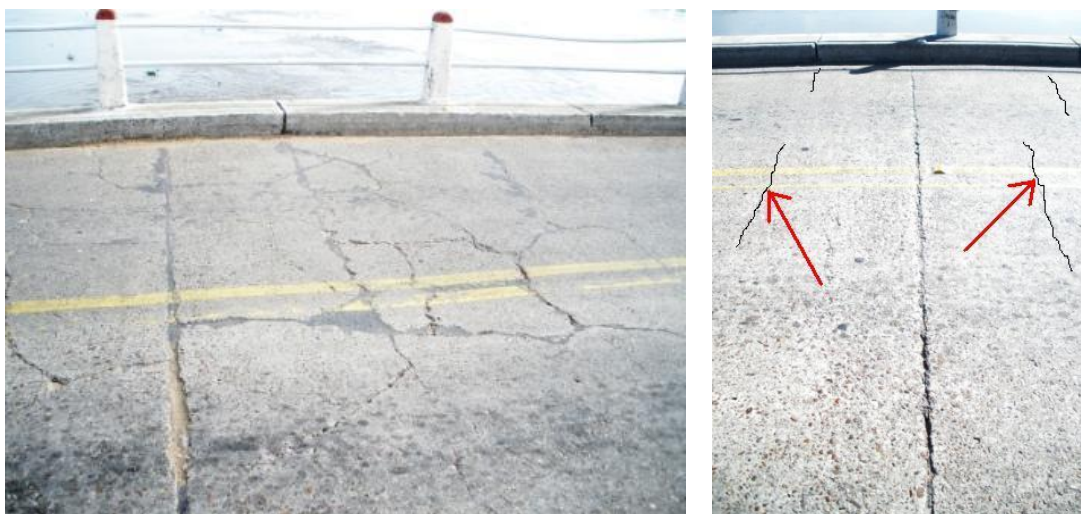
Fisuras tipo en los paños del sector sur y norte respectivamente.
